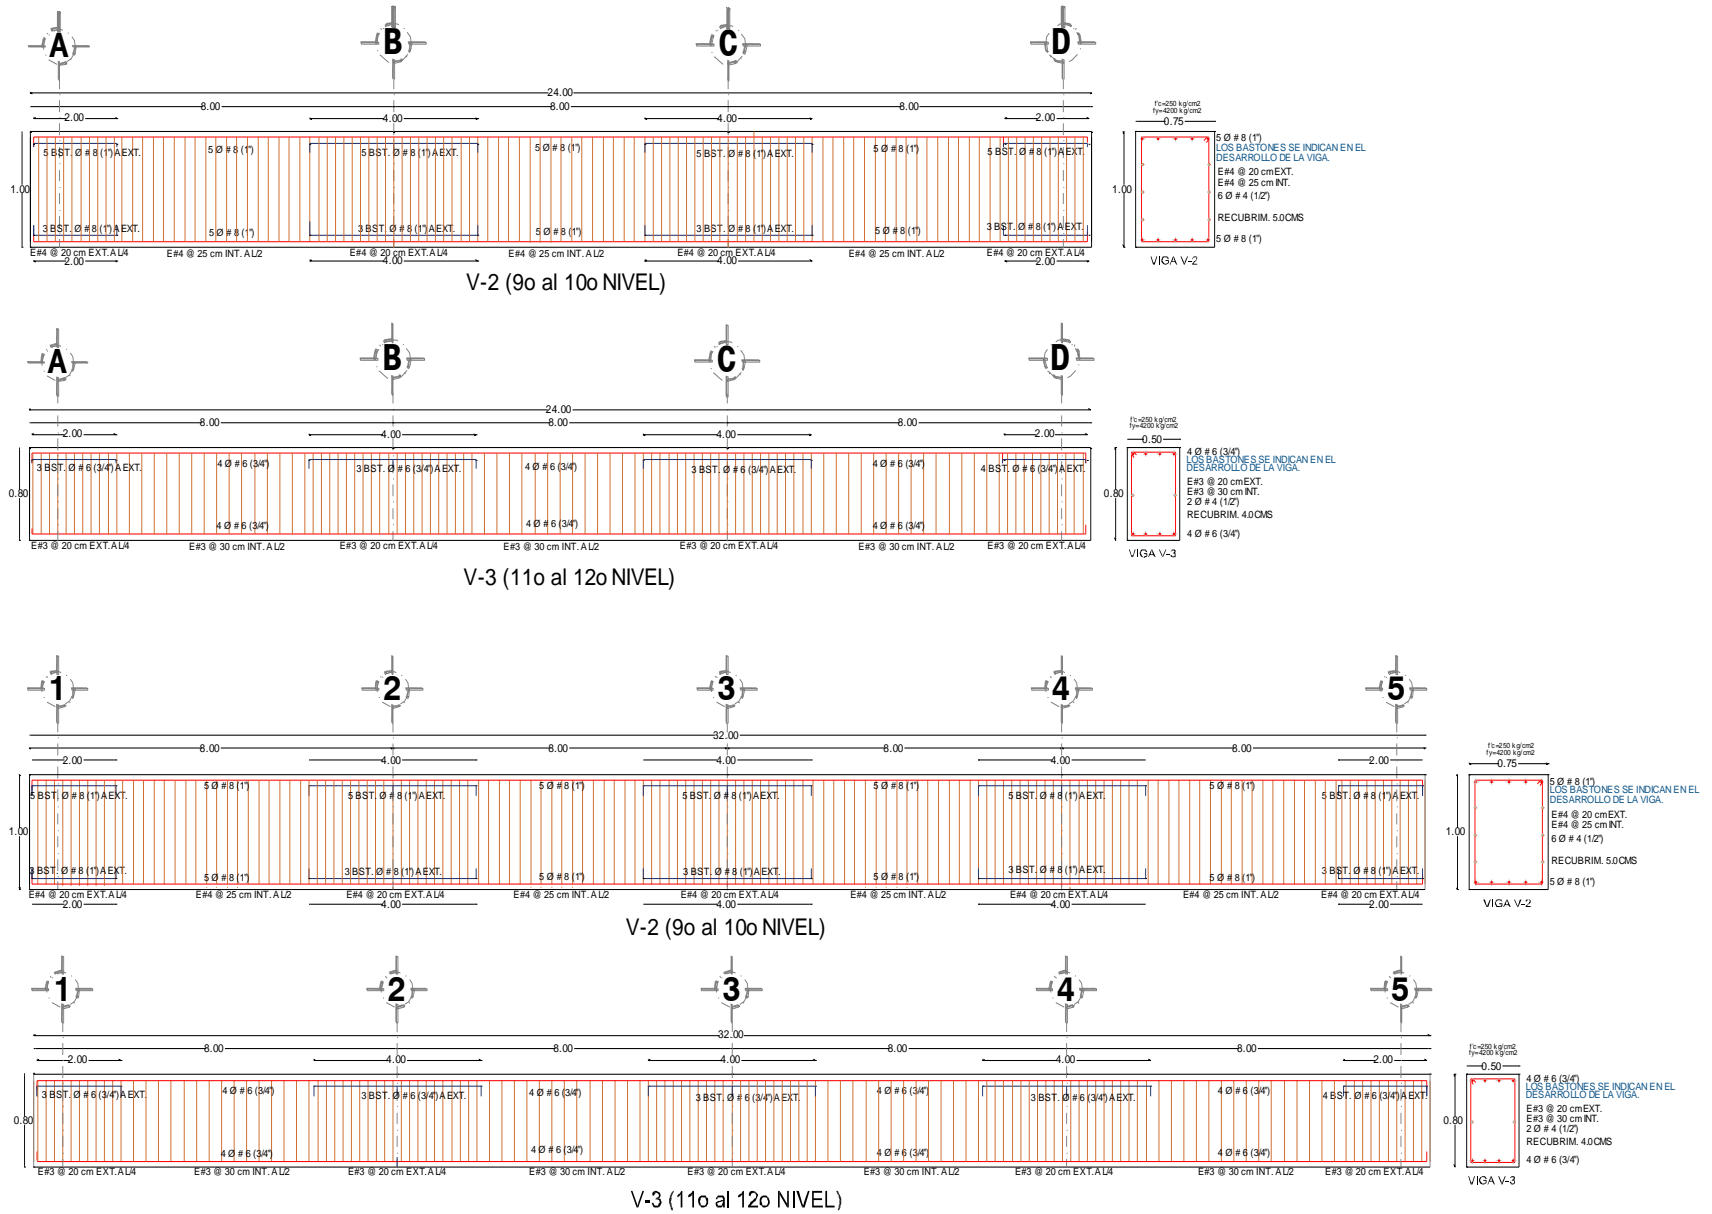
Detallado de armado de vigas de edificio de 12 niveles con base a la hipótesis de las NTCC-04.
